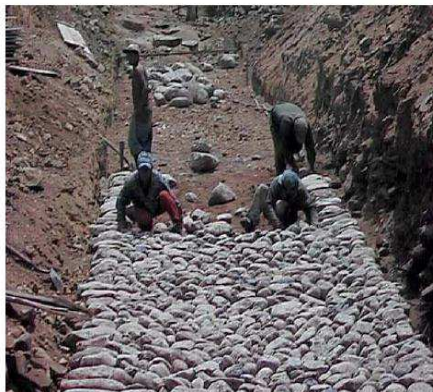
Forma de colocar las piedras para un enrocado colocado a mano
